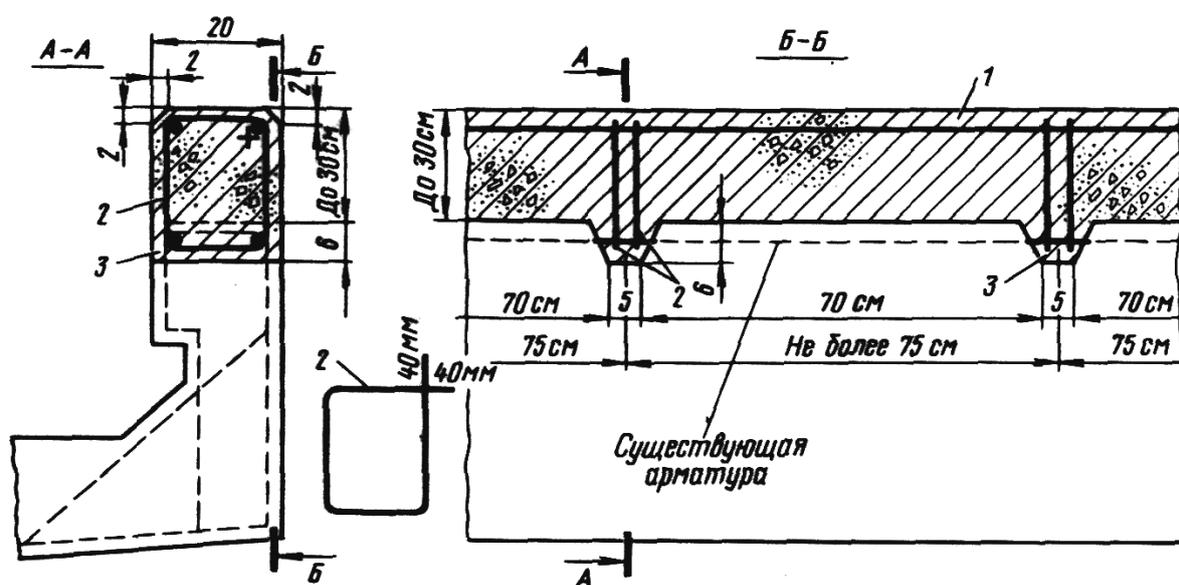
Наращивание бортов пролетного строения бетонированием:
